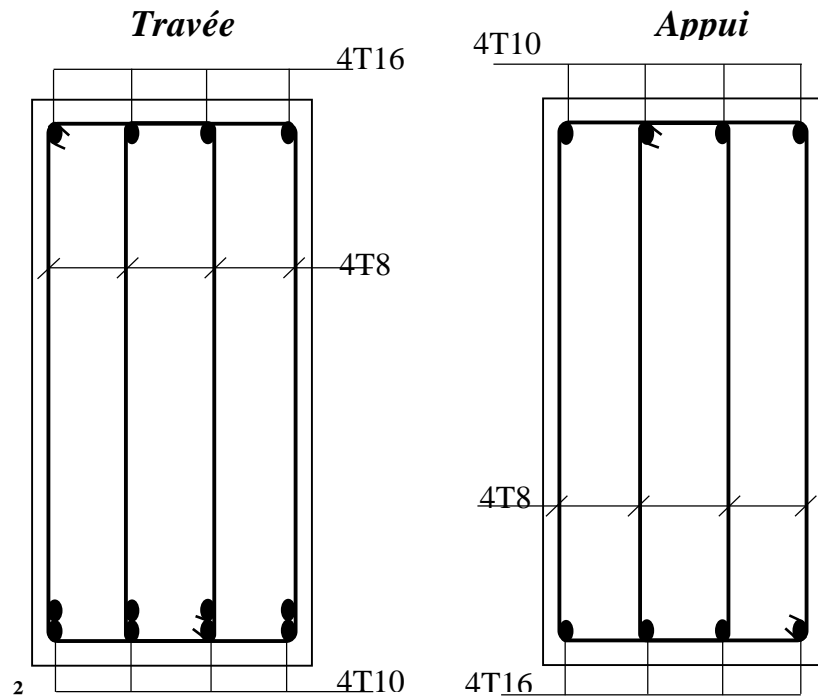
Schéma de Ferrailage des Poutres secondaire
